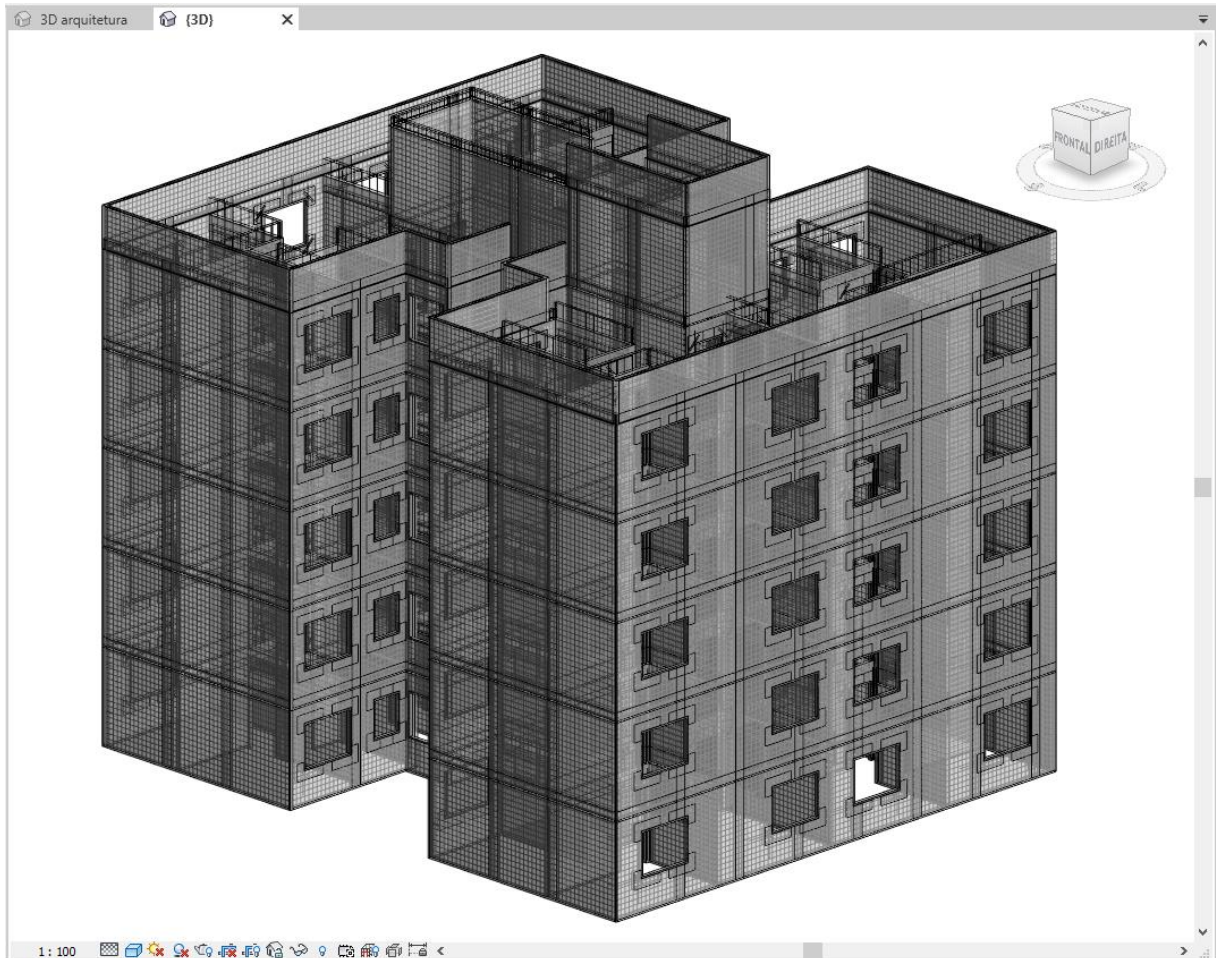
Modelagem completa das paredes estruturais armadas.
